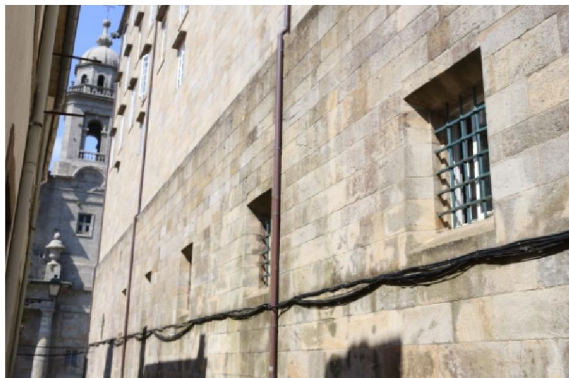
Planta baja de la fachada oeste en la zona norte de la calle Val de Deus. Al fondo se observa un vano redondo seguido de cinco rectangulares en la foto y otros tres a continuación.
